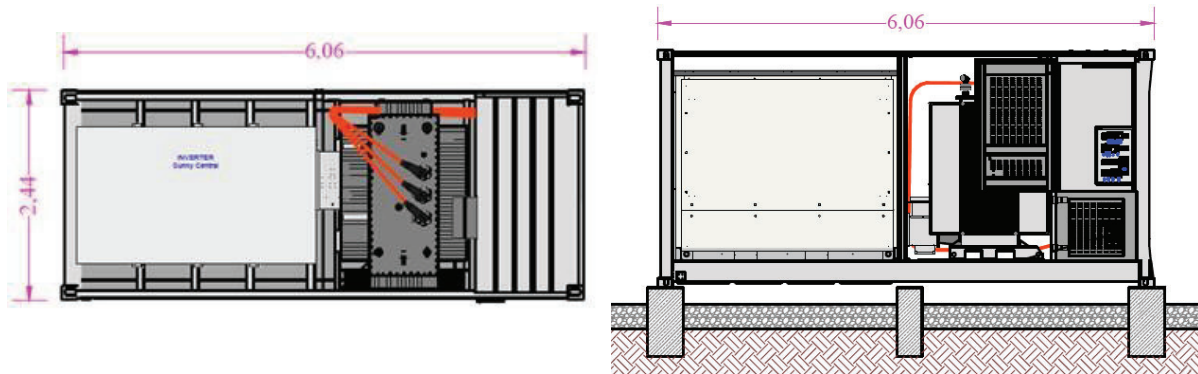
Pianta e profilo dei Cabinet Inverter
